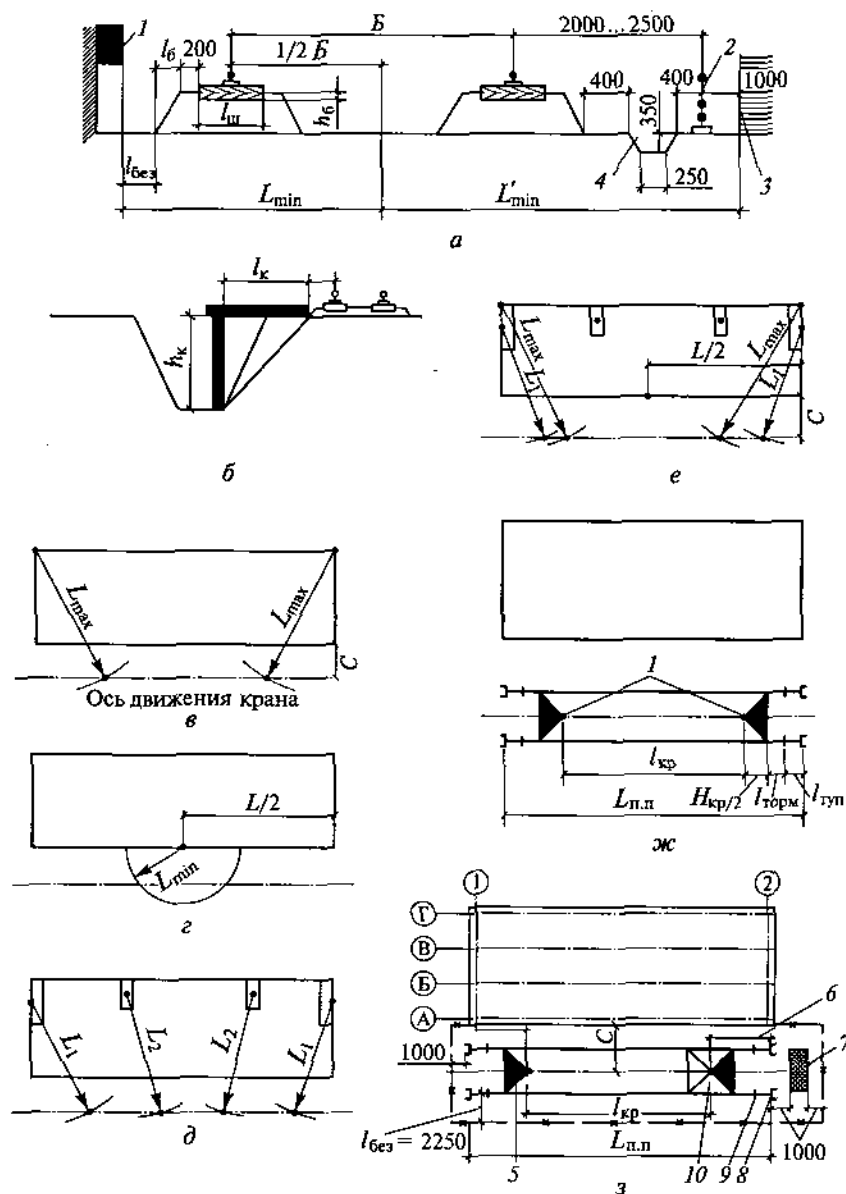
Схема привязки и расчета подкрановых путей на стройгенплане: а, б — схемы для расчета поперечной привязки у здания и выемки; в, г, д, е, ж — то же, для продольной привязки; з — схемы привязки подкрановых путей; С — расстояние от оси крана до здания; 1 — здание; 2 — ограждение; 3 — зона склада; 4 — канава; 5 — крайние стоянки крана; 6 — привязка крайней стоянки к оси здания; 7 — контрольный груз; 8 — конец рельса; 9 — место установки тупика; 10 — база крана
